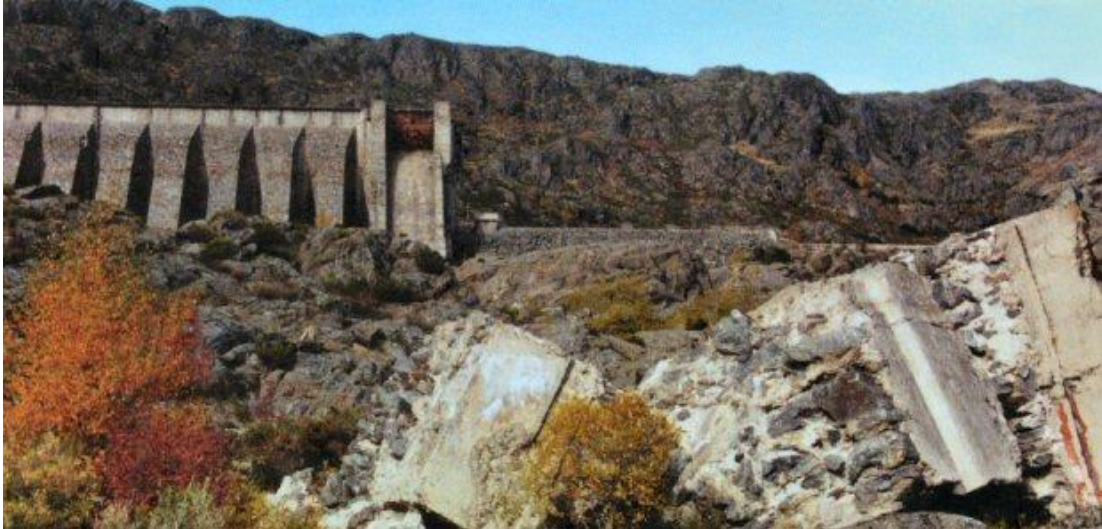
Presa Vega de Tera, España (hormigón), fallo por mala construcción, 1959
